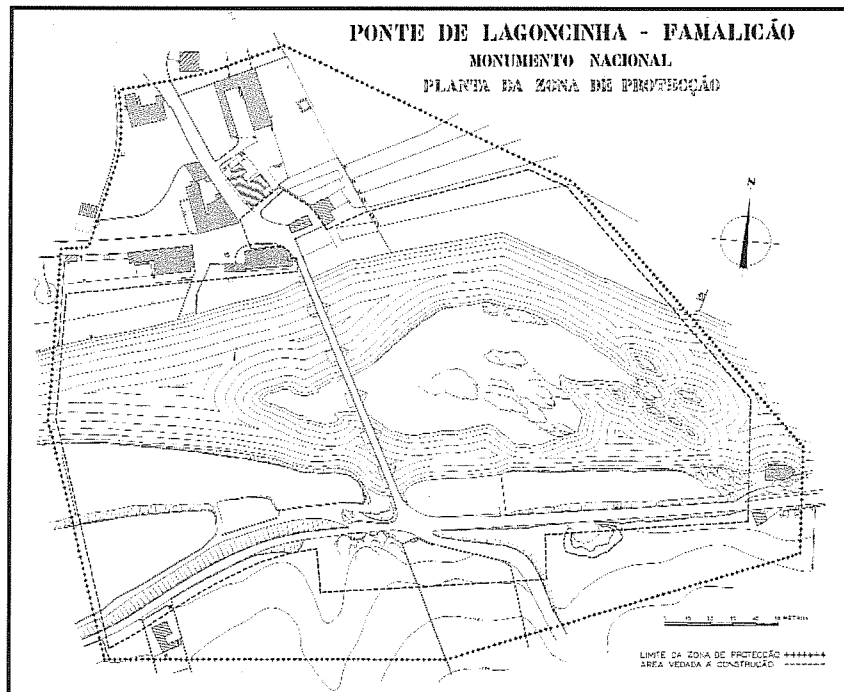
Planta de localização da Ponte da Lagoncinha.
